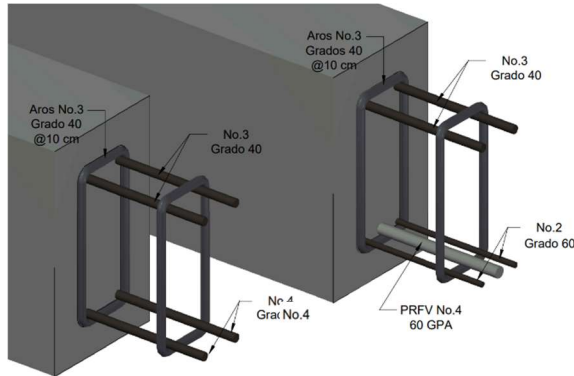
Esquema 3D de la armadura de las vigas construidas.
